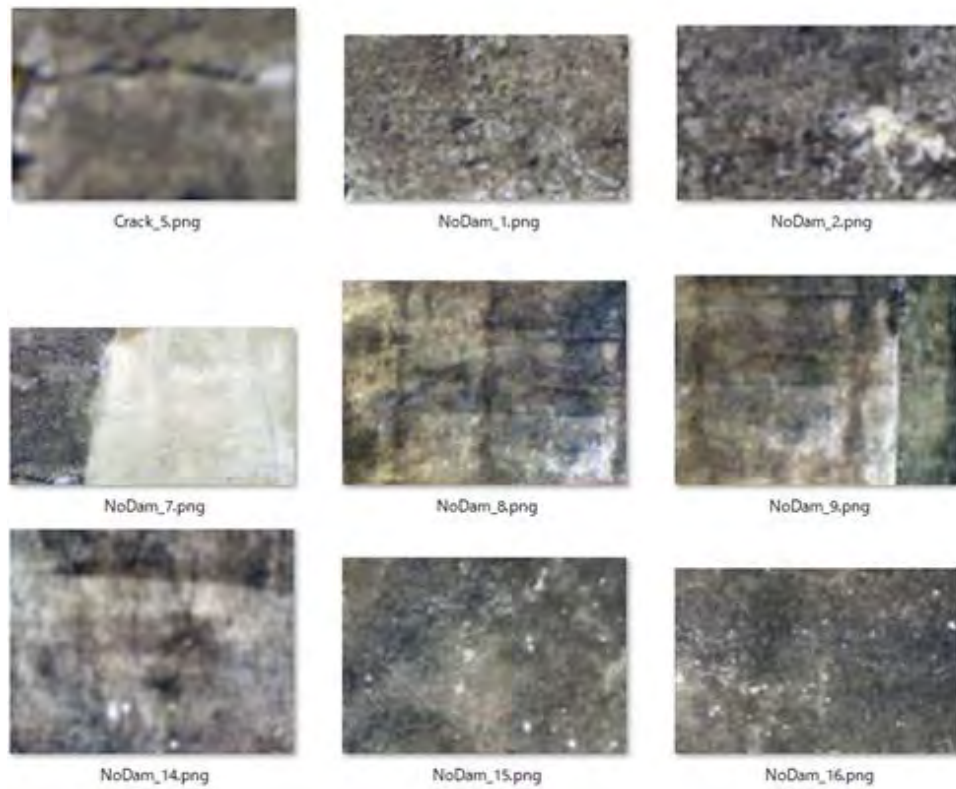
ひび割れ無しと判読された画像
